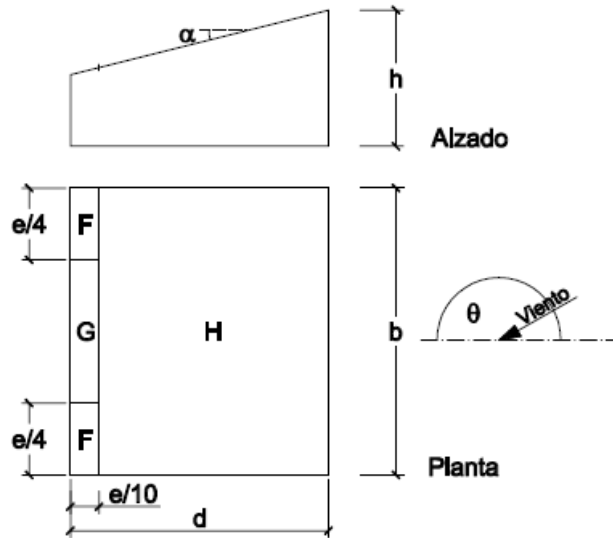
Zonas de la cubierta de la nave adosada para viento transversal 180° .
